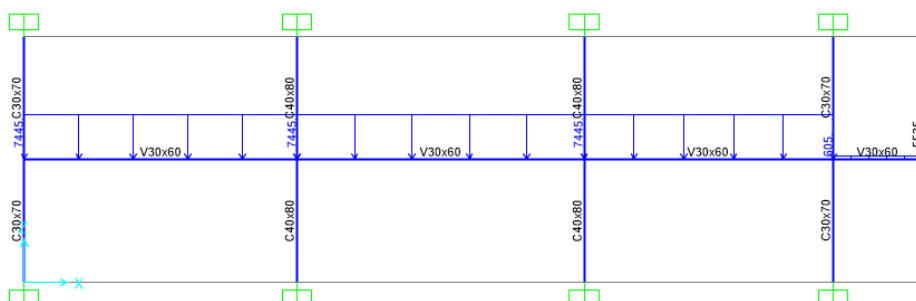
Modelo estructural utilizado para el análisis de la viga V-9 (ton/m)
